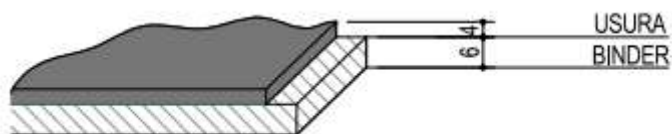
Particolare del Pacchetto 1 di rifacimento pavimentazione stradale
